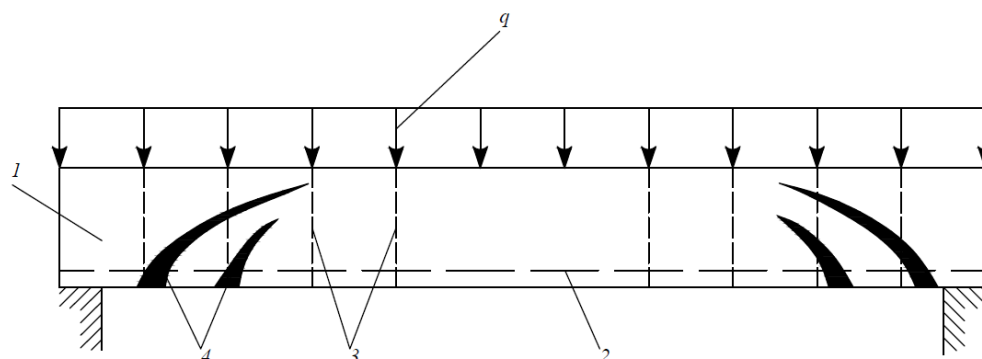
Трещины в наклонном сечении: 1 – изгибаемый элемент; 2 – рабочая арматура растянутой зоны, напряжения в которой достигли предела текучести в наклонном сечении; 3 – поперечная арматура, напряжения в которой достигли предела текучести в
